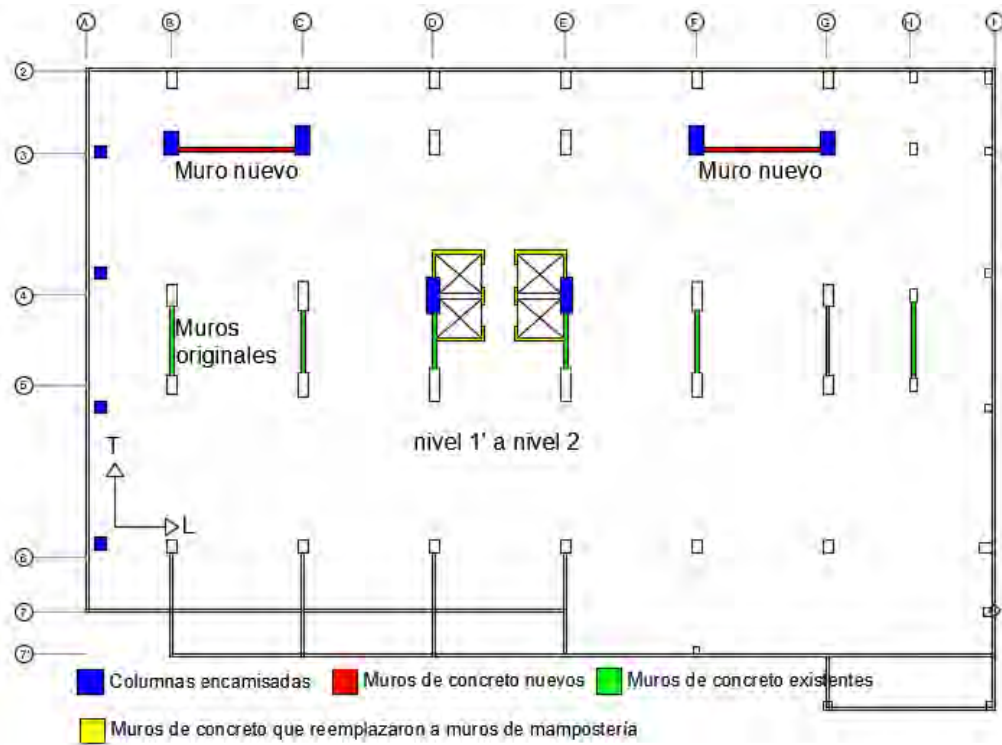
Elementos estructurales reforzados en los niveles 1' al nivel 2
